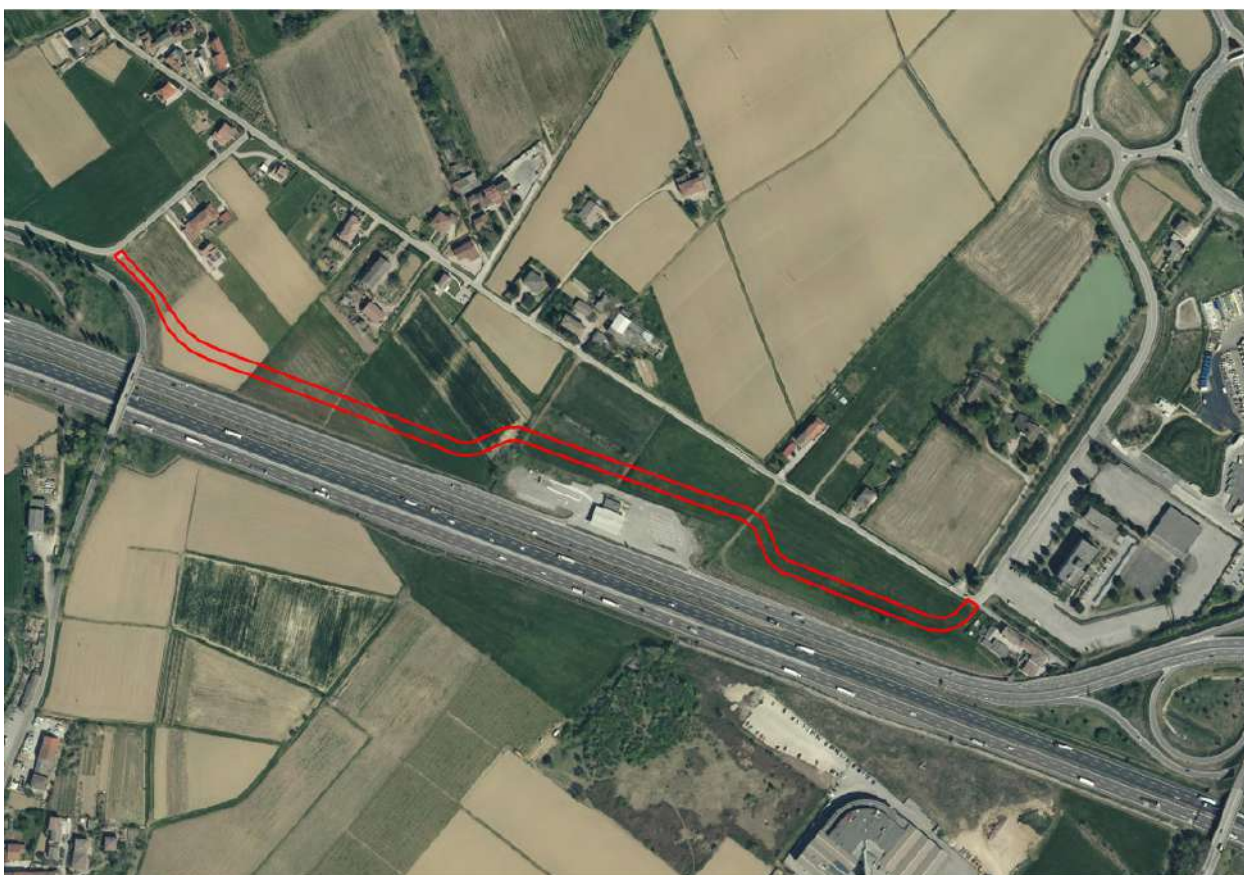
Individuazione da ortofoto del Veneto al 2021.
